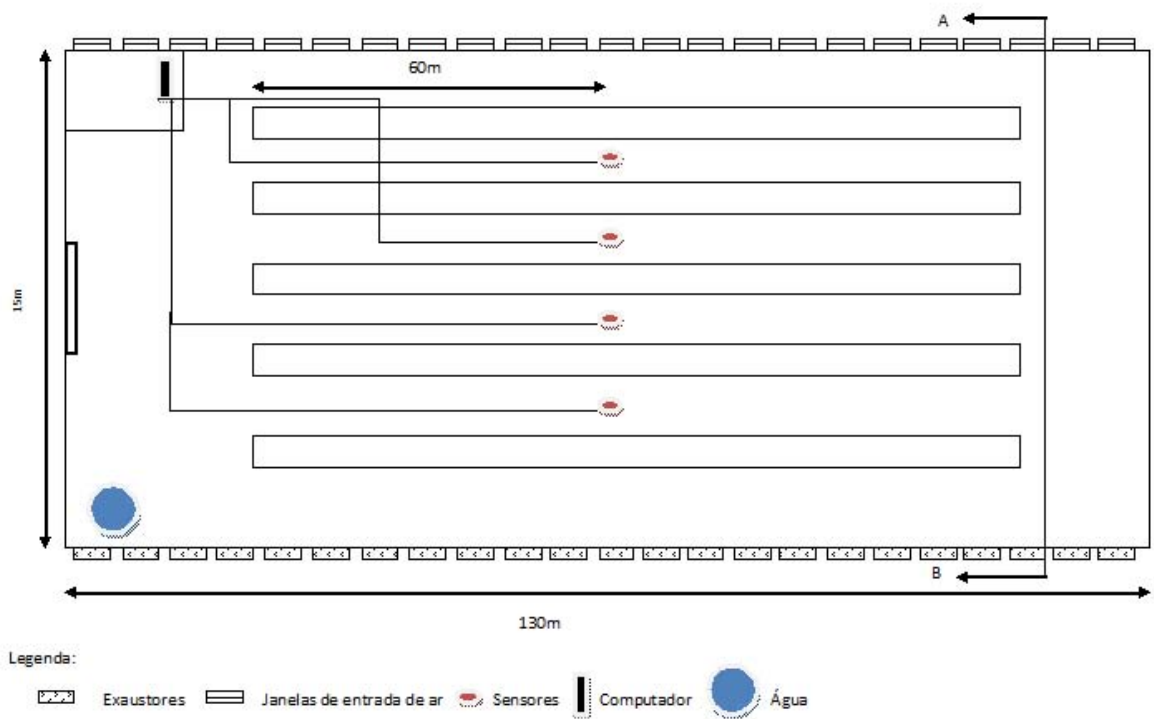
Planta baixa do galpão de produção com localização dos equipamentos
